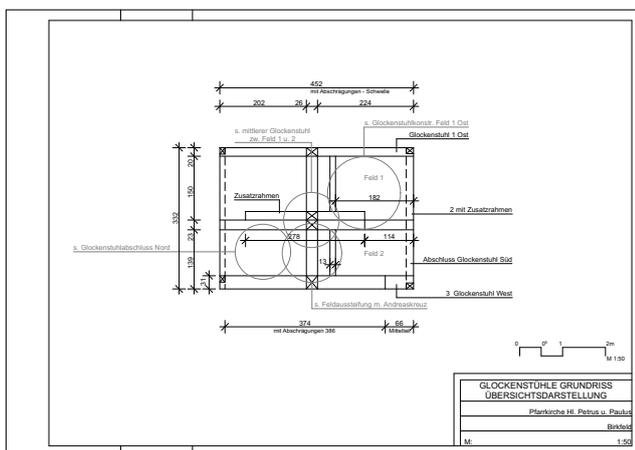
Glockenstuhl Pfarrkirche Birkfeld, Grundrissplan der Fachwerkkonstruktion
